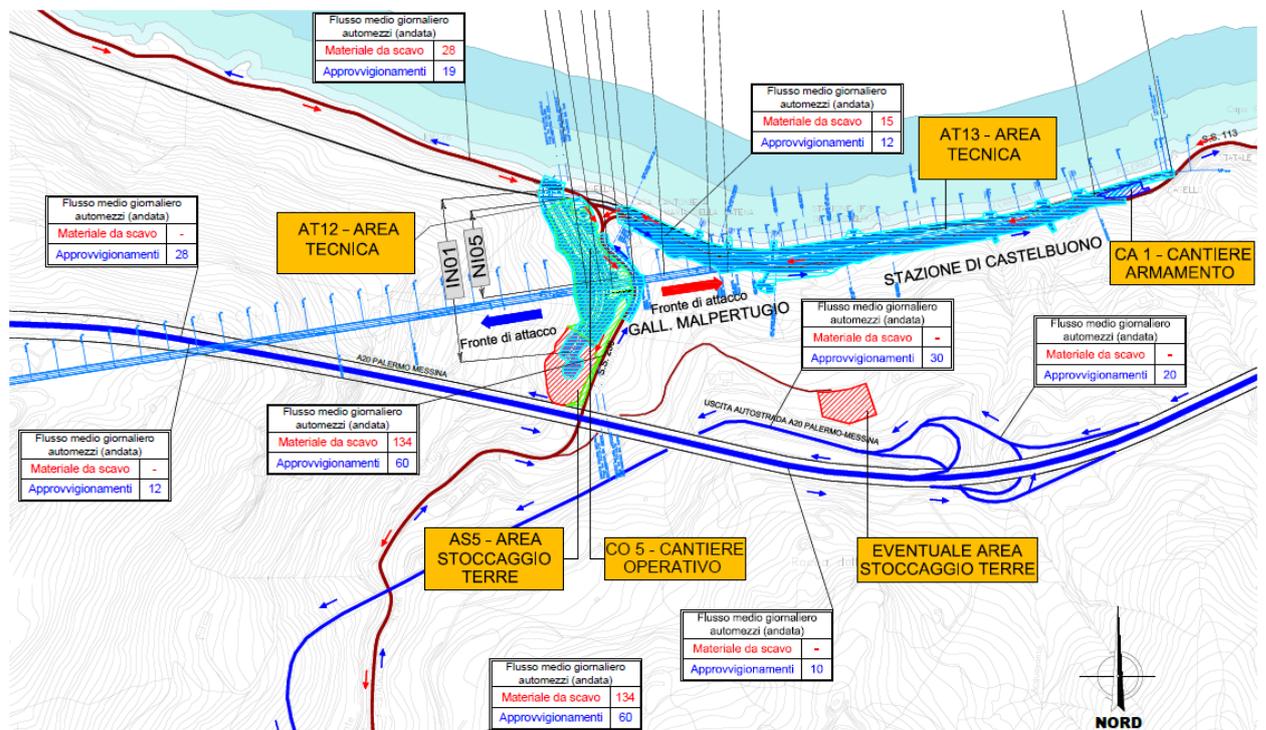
Stralcio planimetria dei flussi area Malpertugio- Castelbuono
